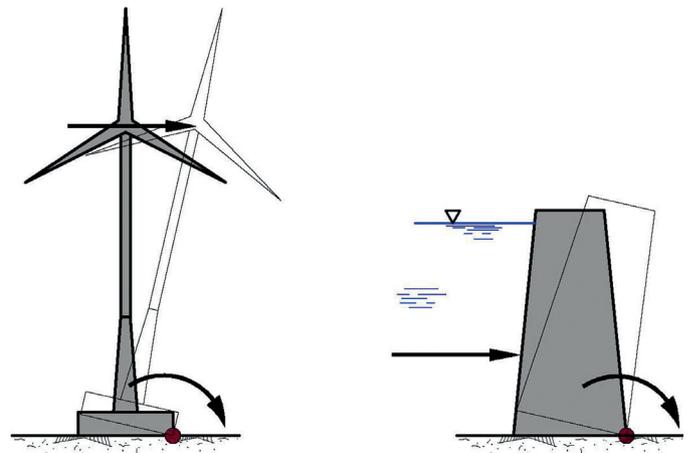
Ejemplos de estado límite de pérdida de equilibrio EQU con el vuelco rígido de una estructura.
